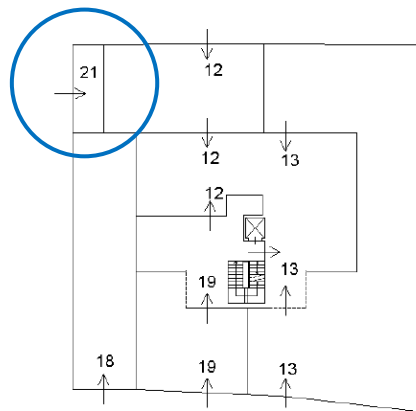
pianta area urbana – estratto dall'elaborato planimetrico.
